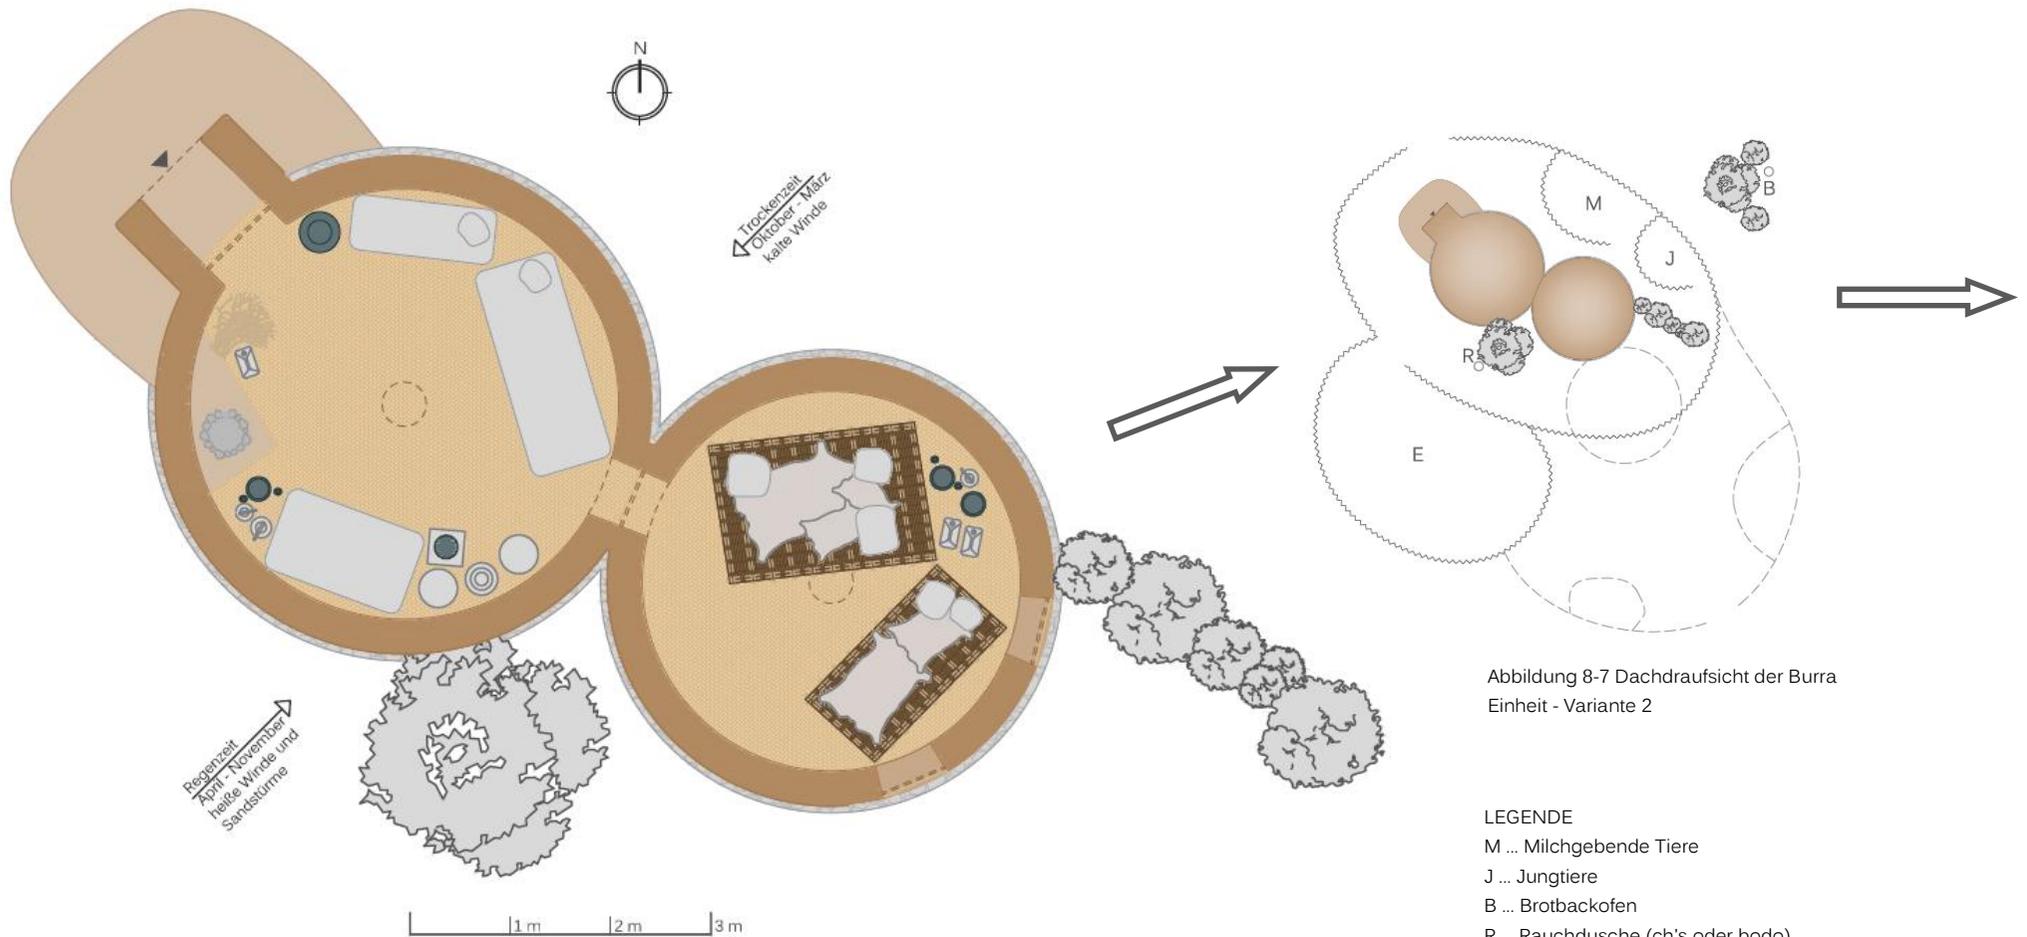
Grundriss der Burra Einheit - Variante 2
